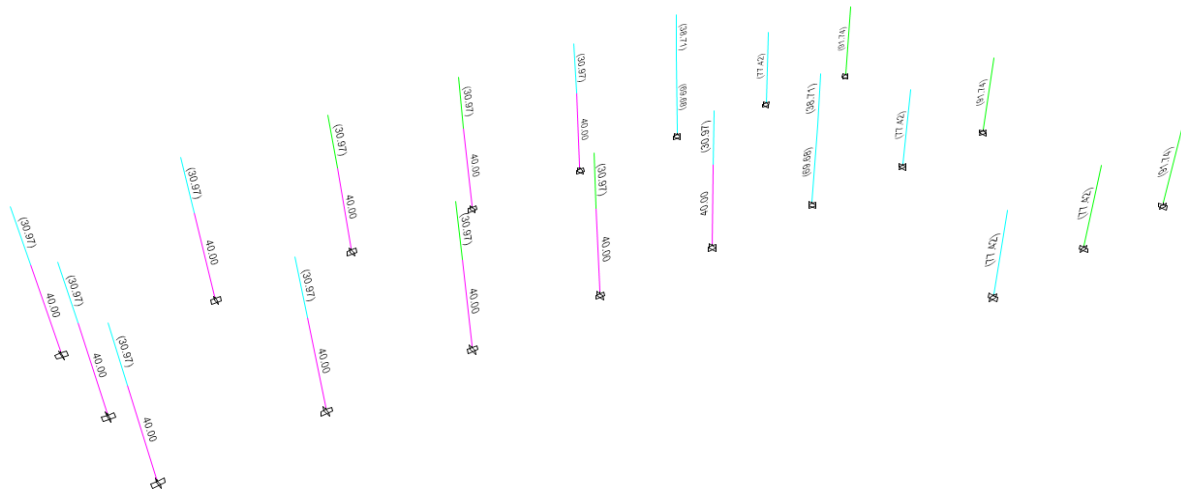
Refuerzo longitudinal columnas restaurante en cm2 y %
